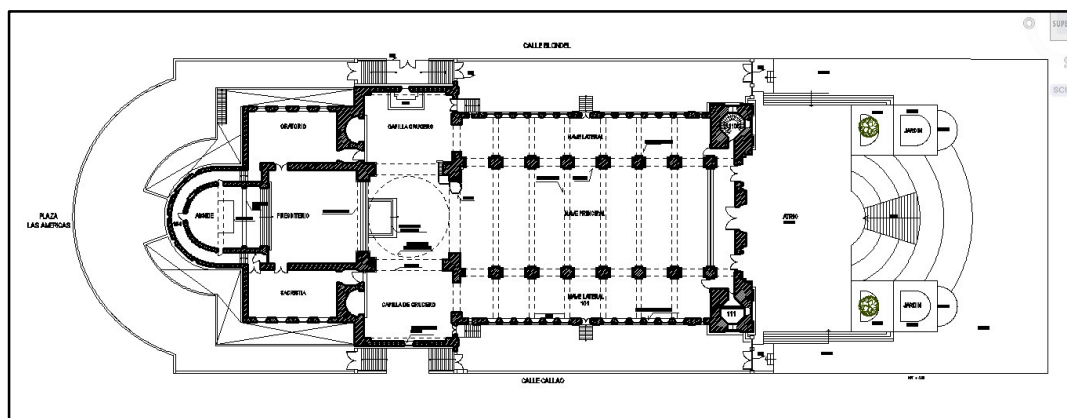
Plano Planta de la Catedral de Tacna (Velasquez 2004)
